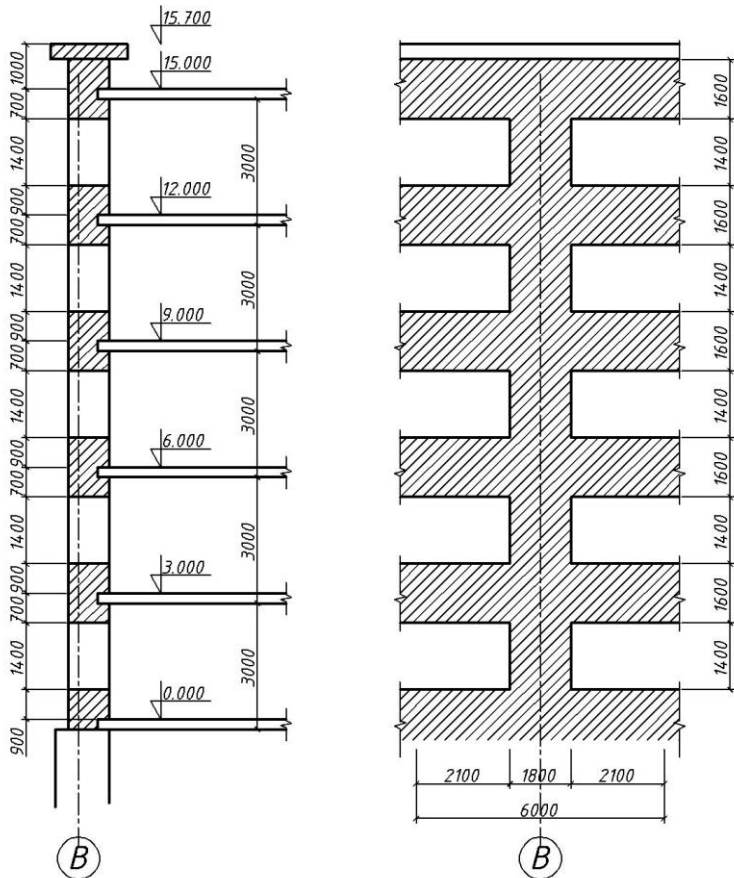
До прикладу 10.6. До збору навантаження на простінок (фрагменти розрізу та фасаду будівлі)
